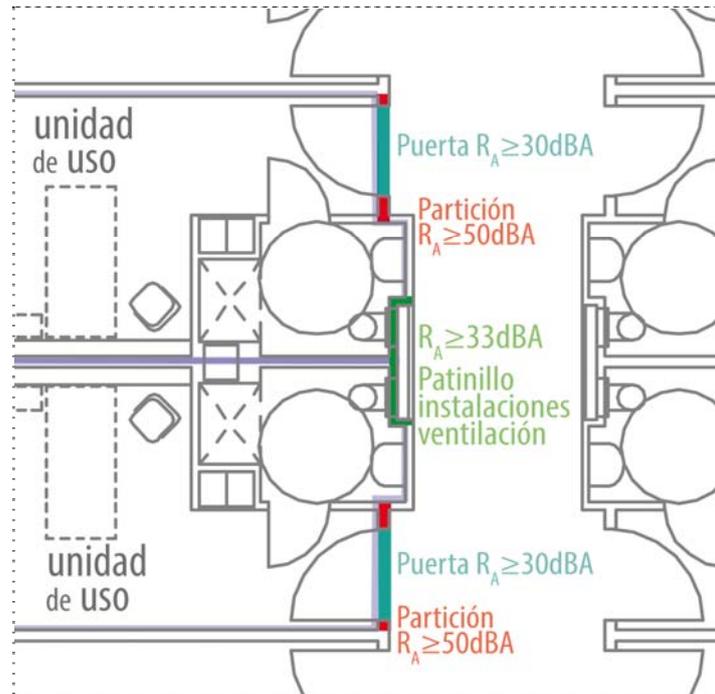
Detalle planta habitaciones con indicación de exigencias aplicables a las particiones con puertas, a las puertas y a los conductos de extracción de aire.
